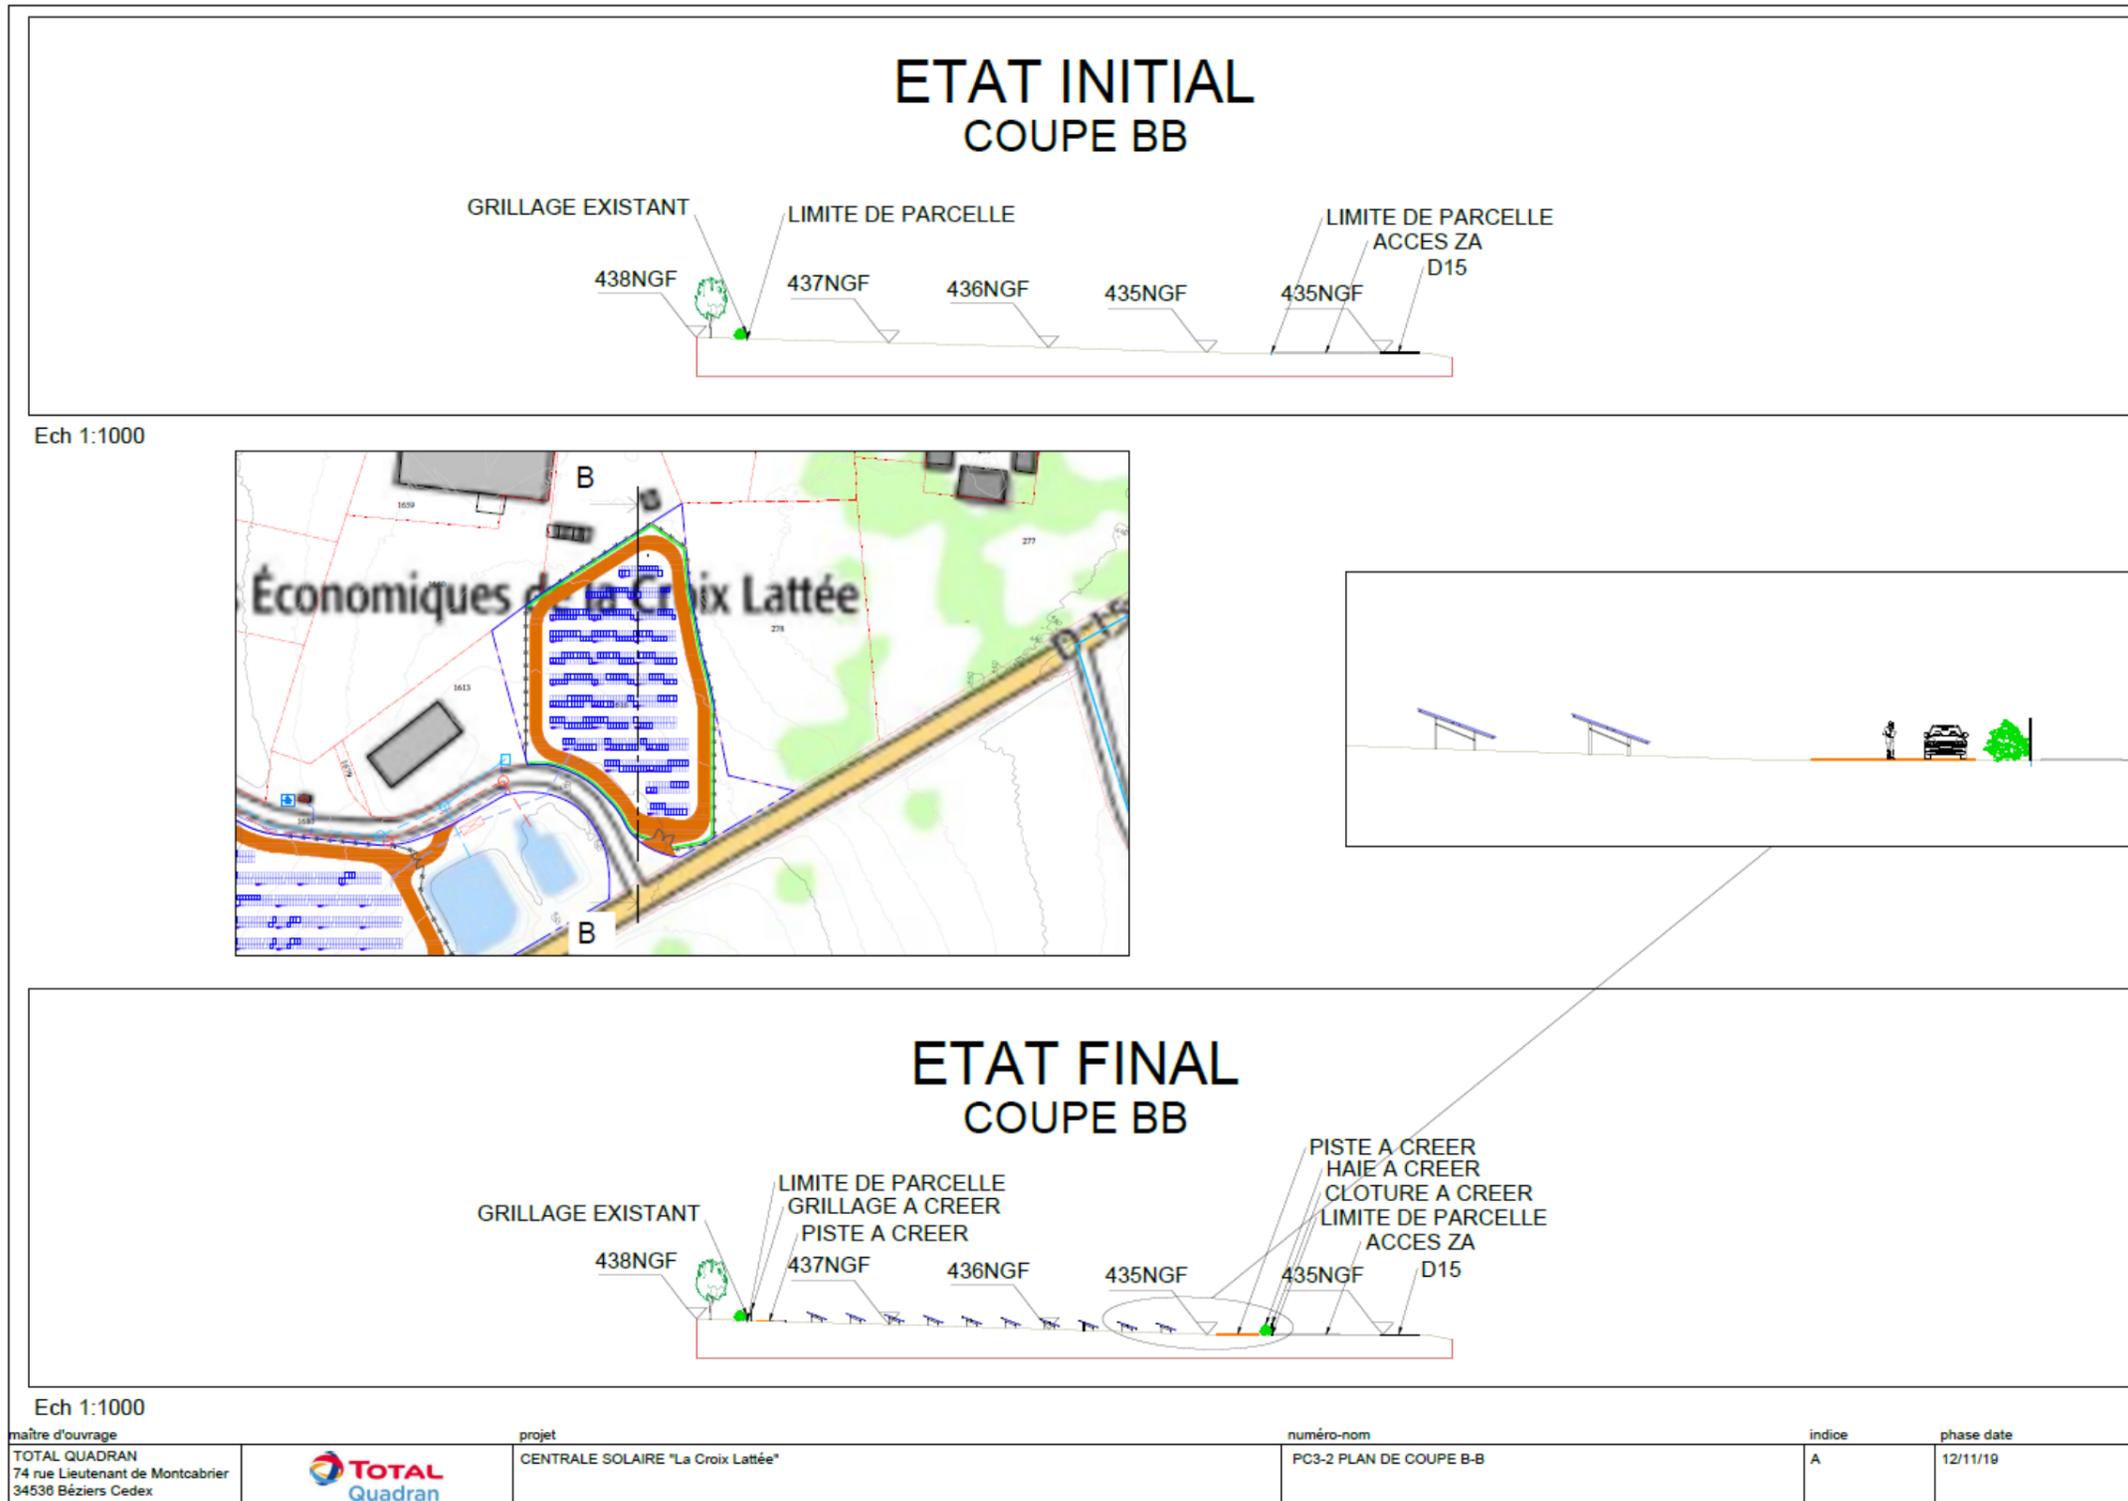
Plan de coupe BB° Echelle 1 : 1 000 (Source : Total Quadran)
